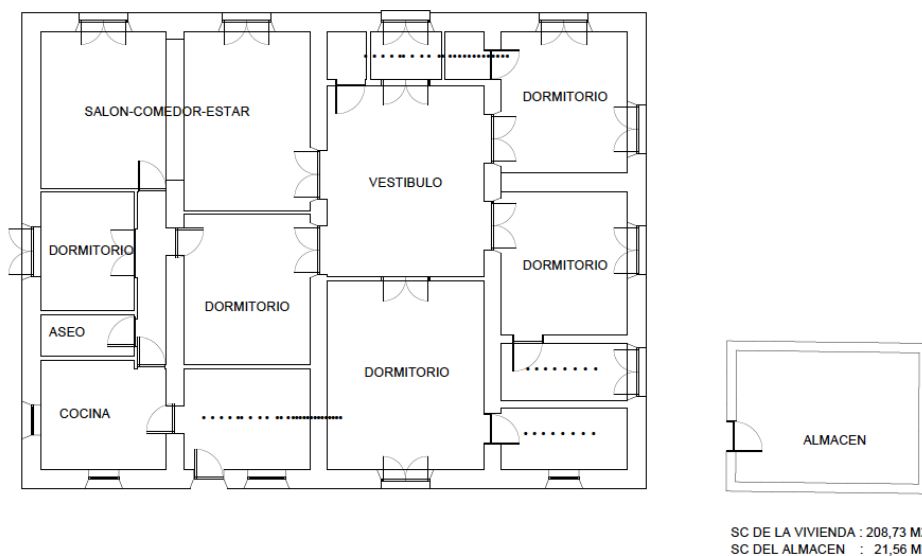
Plano de la vivienda. (Fuente: Informe de Tasación)
